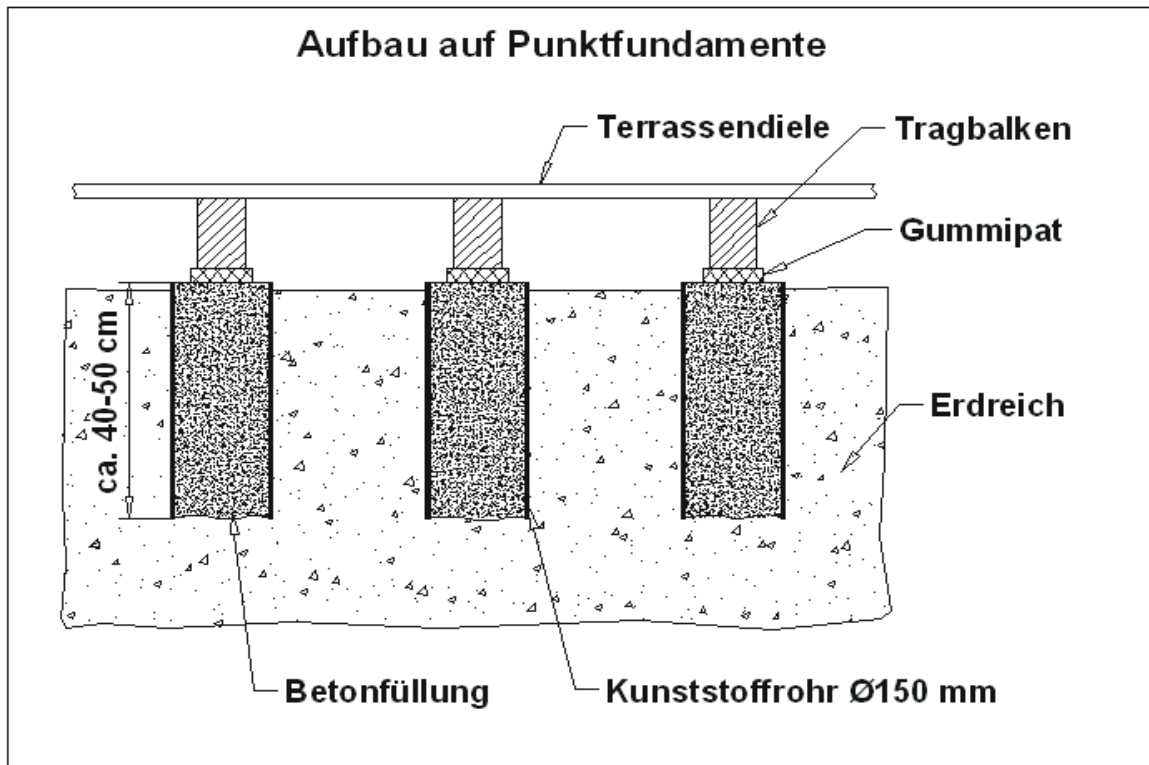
Aufbau der Unterkonstruktion mit Punktfundamenten
